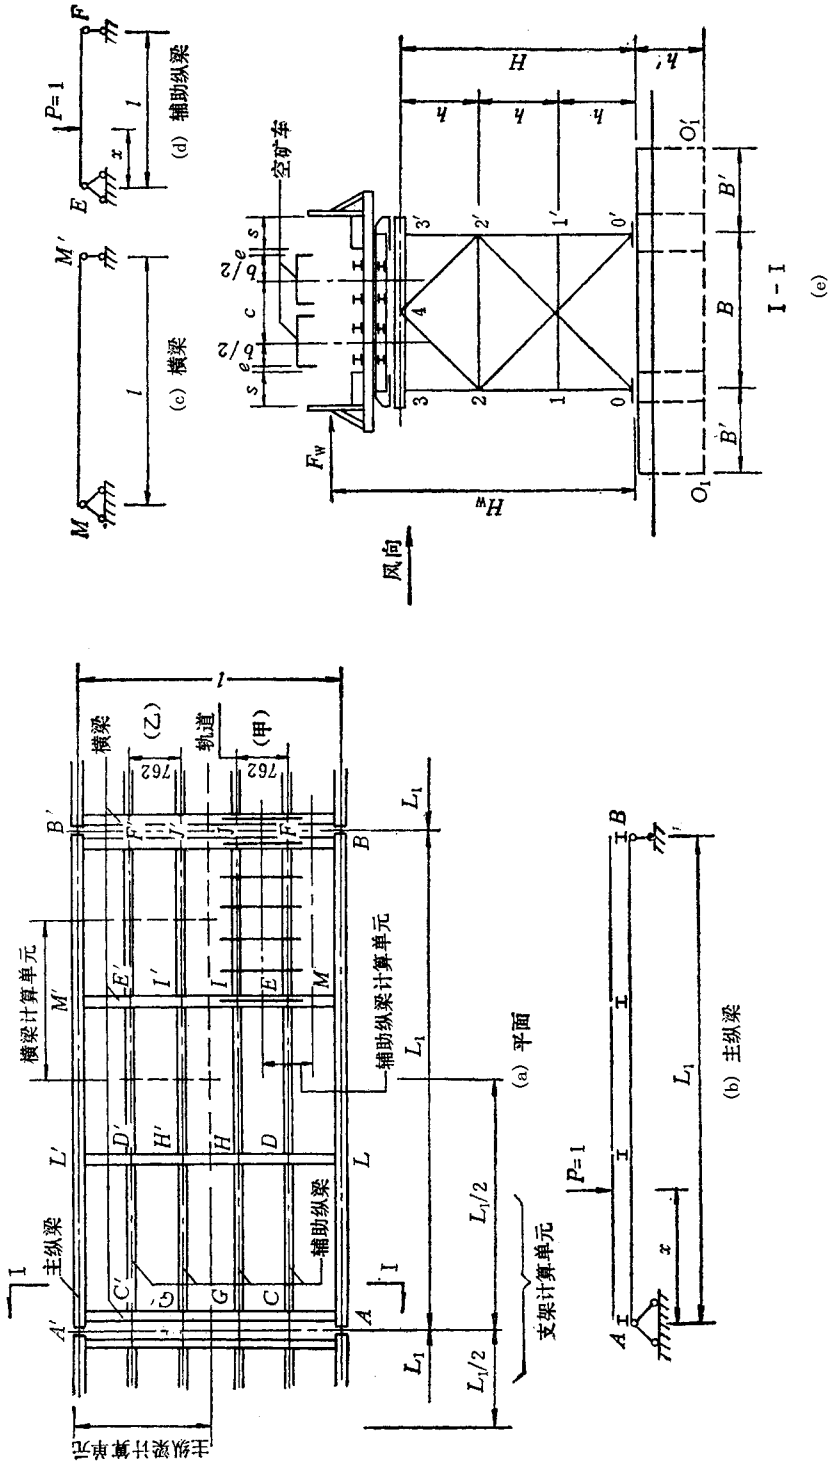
纵横梁桥面系计算单元及计算模型、平面支架计算简图
